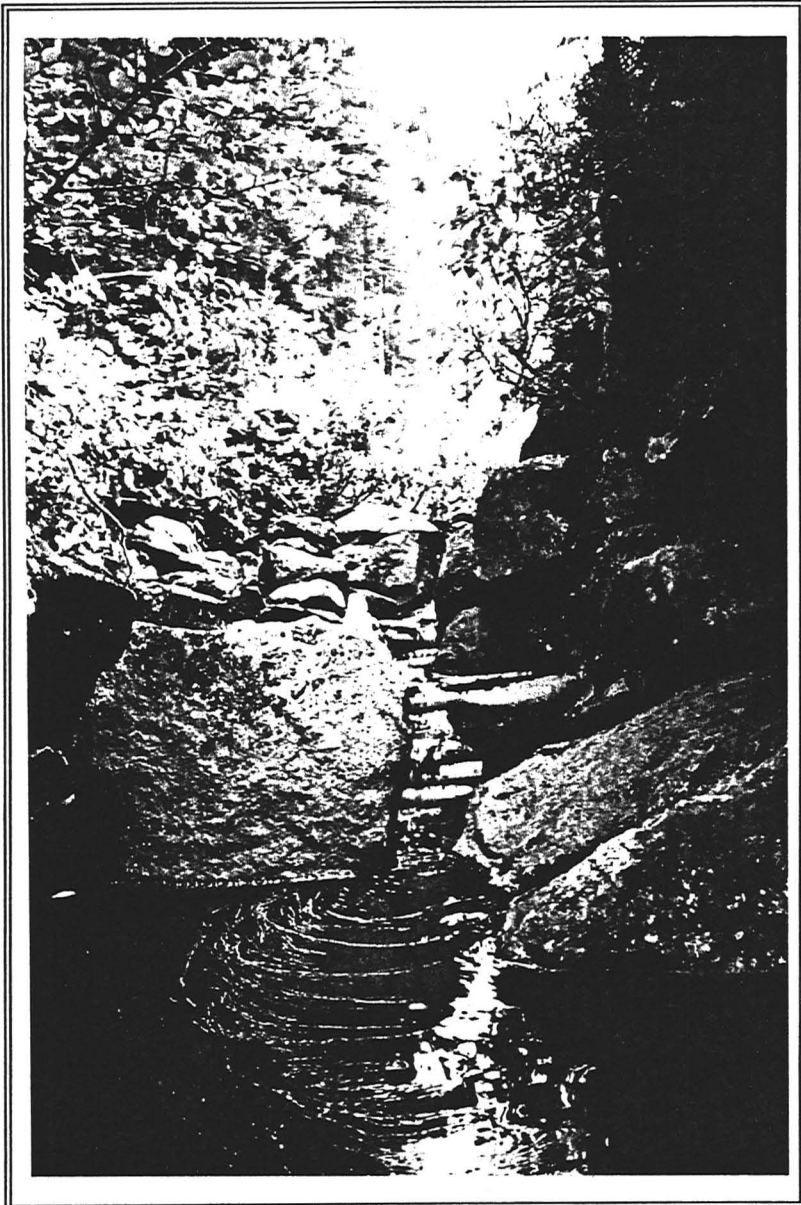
Reprofilage de la chute en cascades facilement franchissables.
